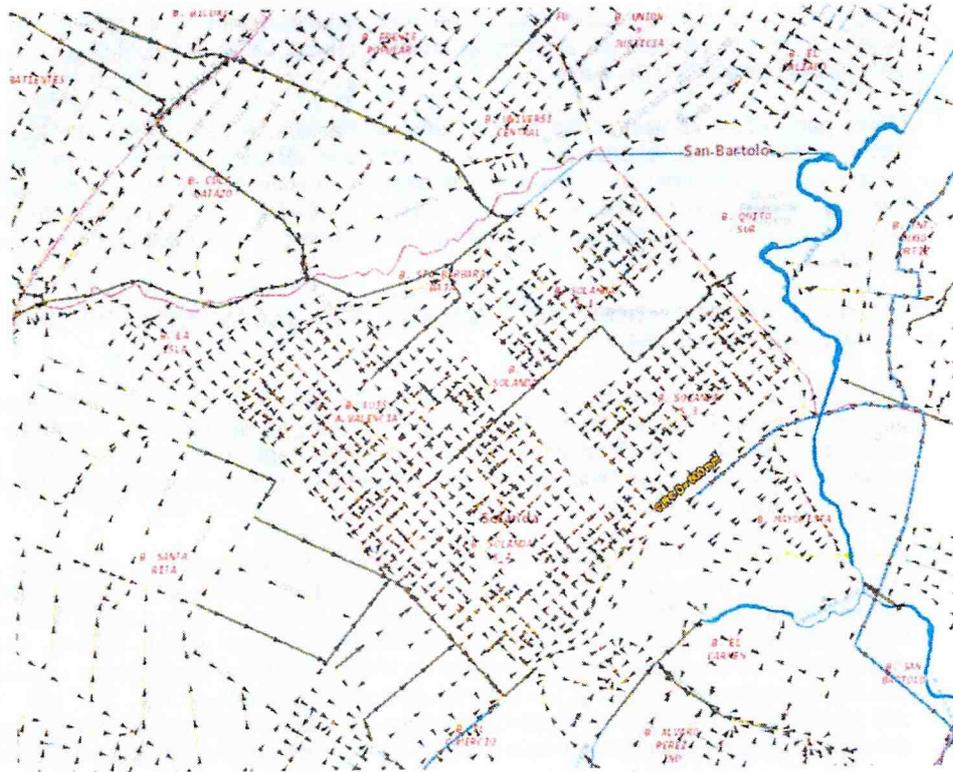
Implantación General del Sistema de ALCANTARILLADO.
